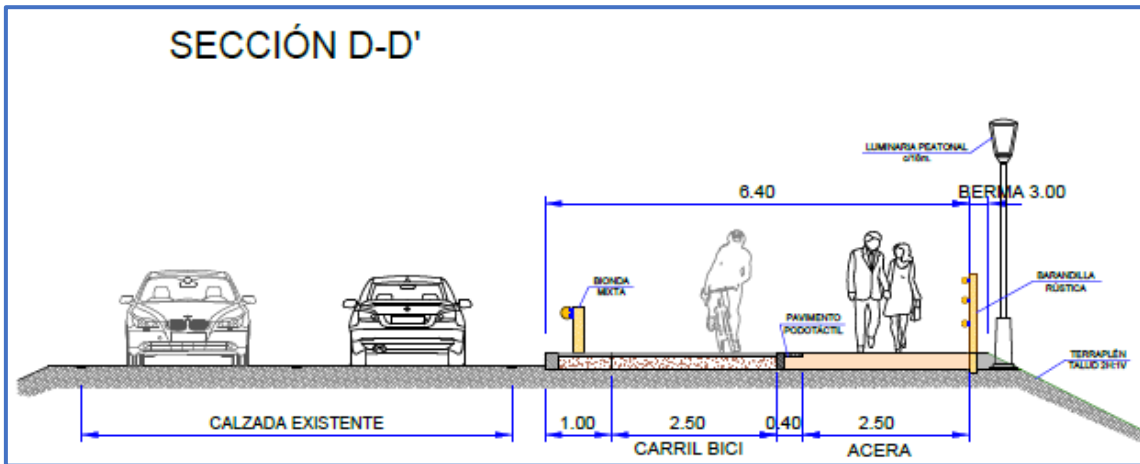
Sección transversal con bionda mixta y berma para alojamiento de alumbrado y barrera rústica.
